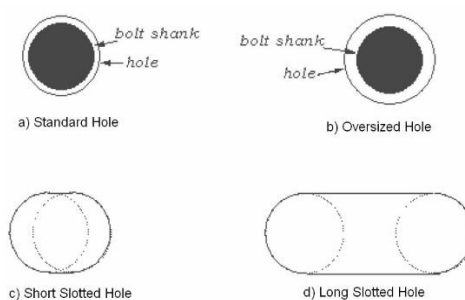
Ilustrasi Jenis Sambungan Baut pada Struktur Baja
